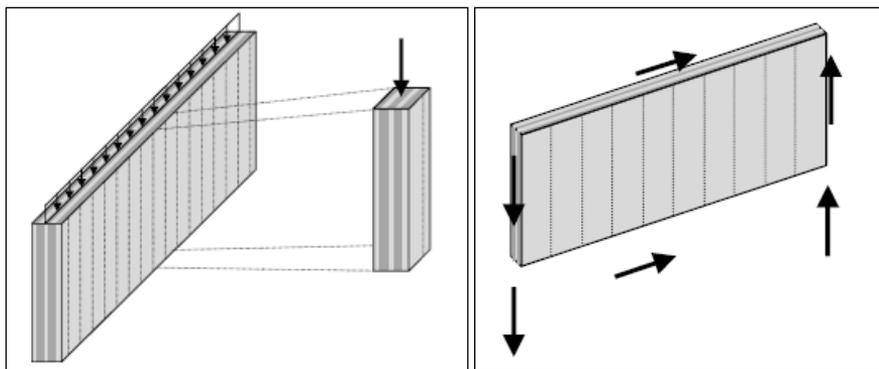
Effetto strutturale dell'elemento piastra.
